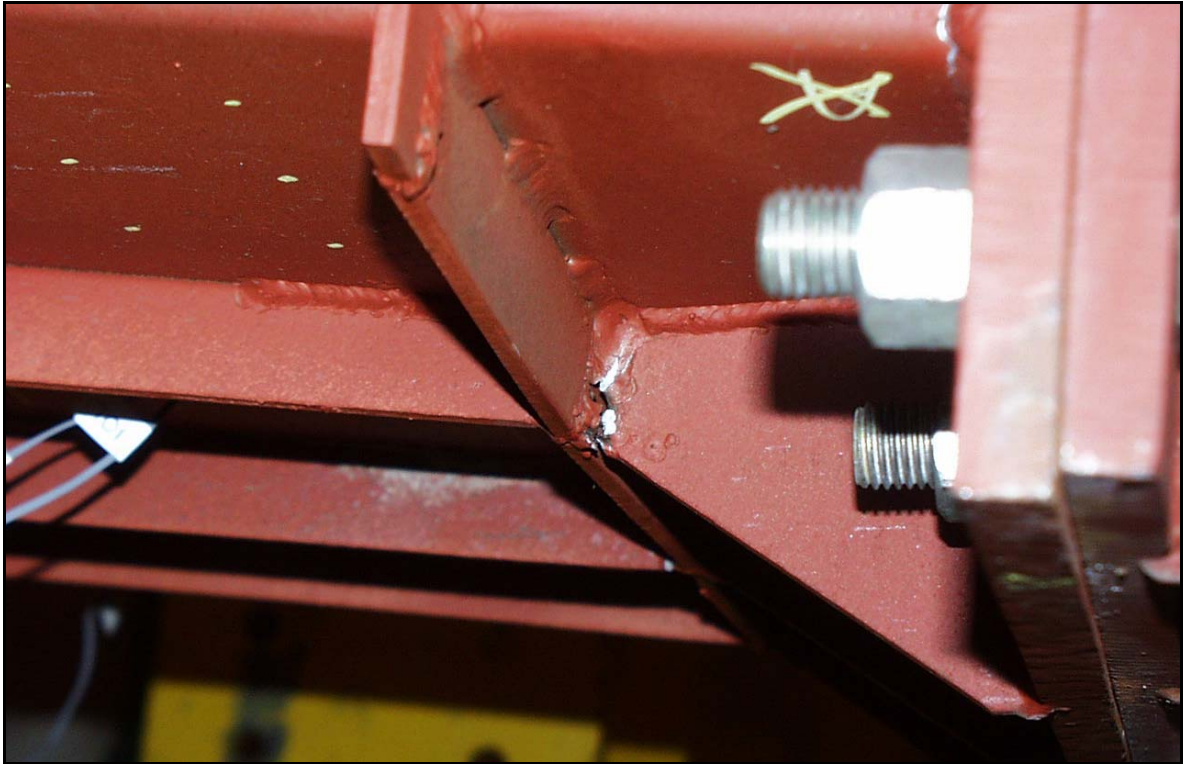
Falha da soldadura do esquadro na fase de colapso.
